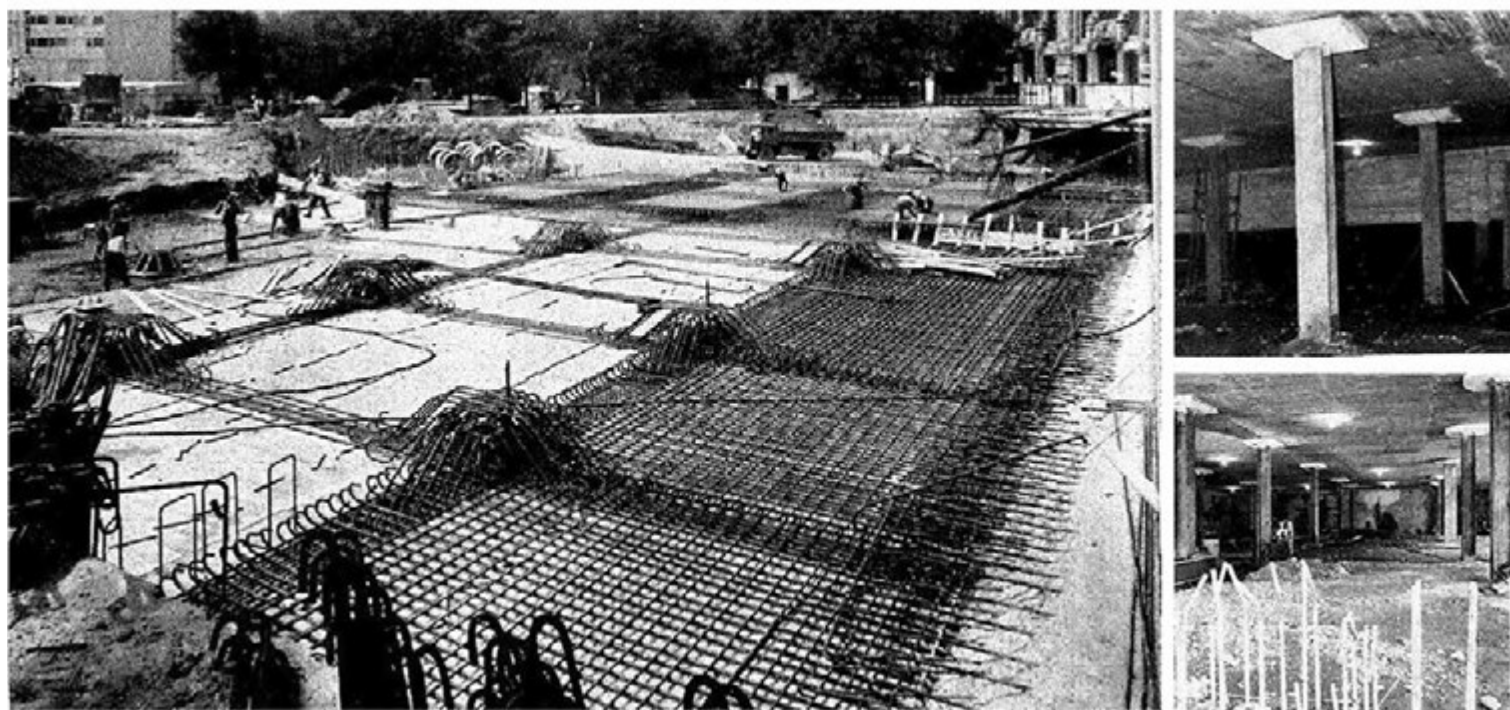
| Armatura del solaio di copertura e scavo sotto lo stesso
